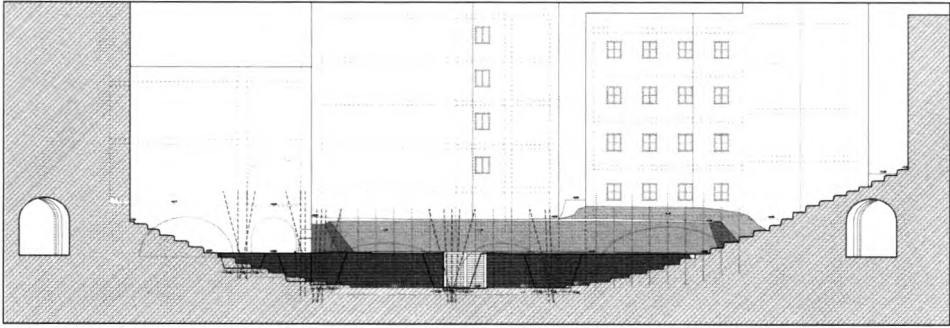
Esquema (en alzado) de consolidación de muros, cimentaciones y rellenos, y de formación de pilastras mediante la técnica de la inyección armada
